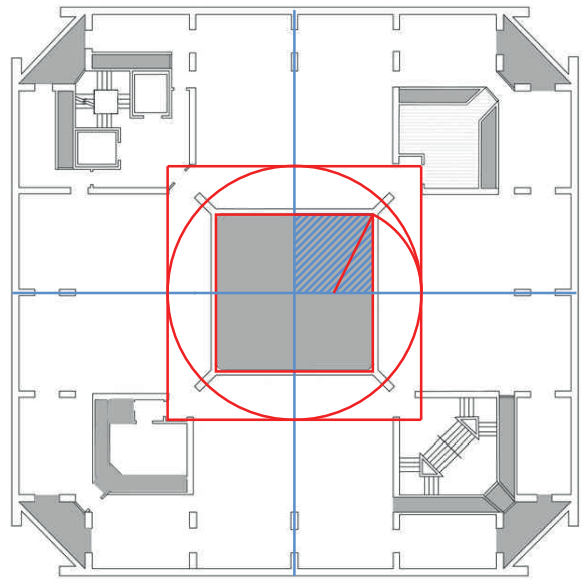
e 140. Corte e planta da biblioteca da Phillips Exeter Academy.
